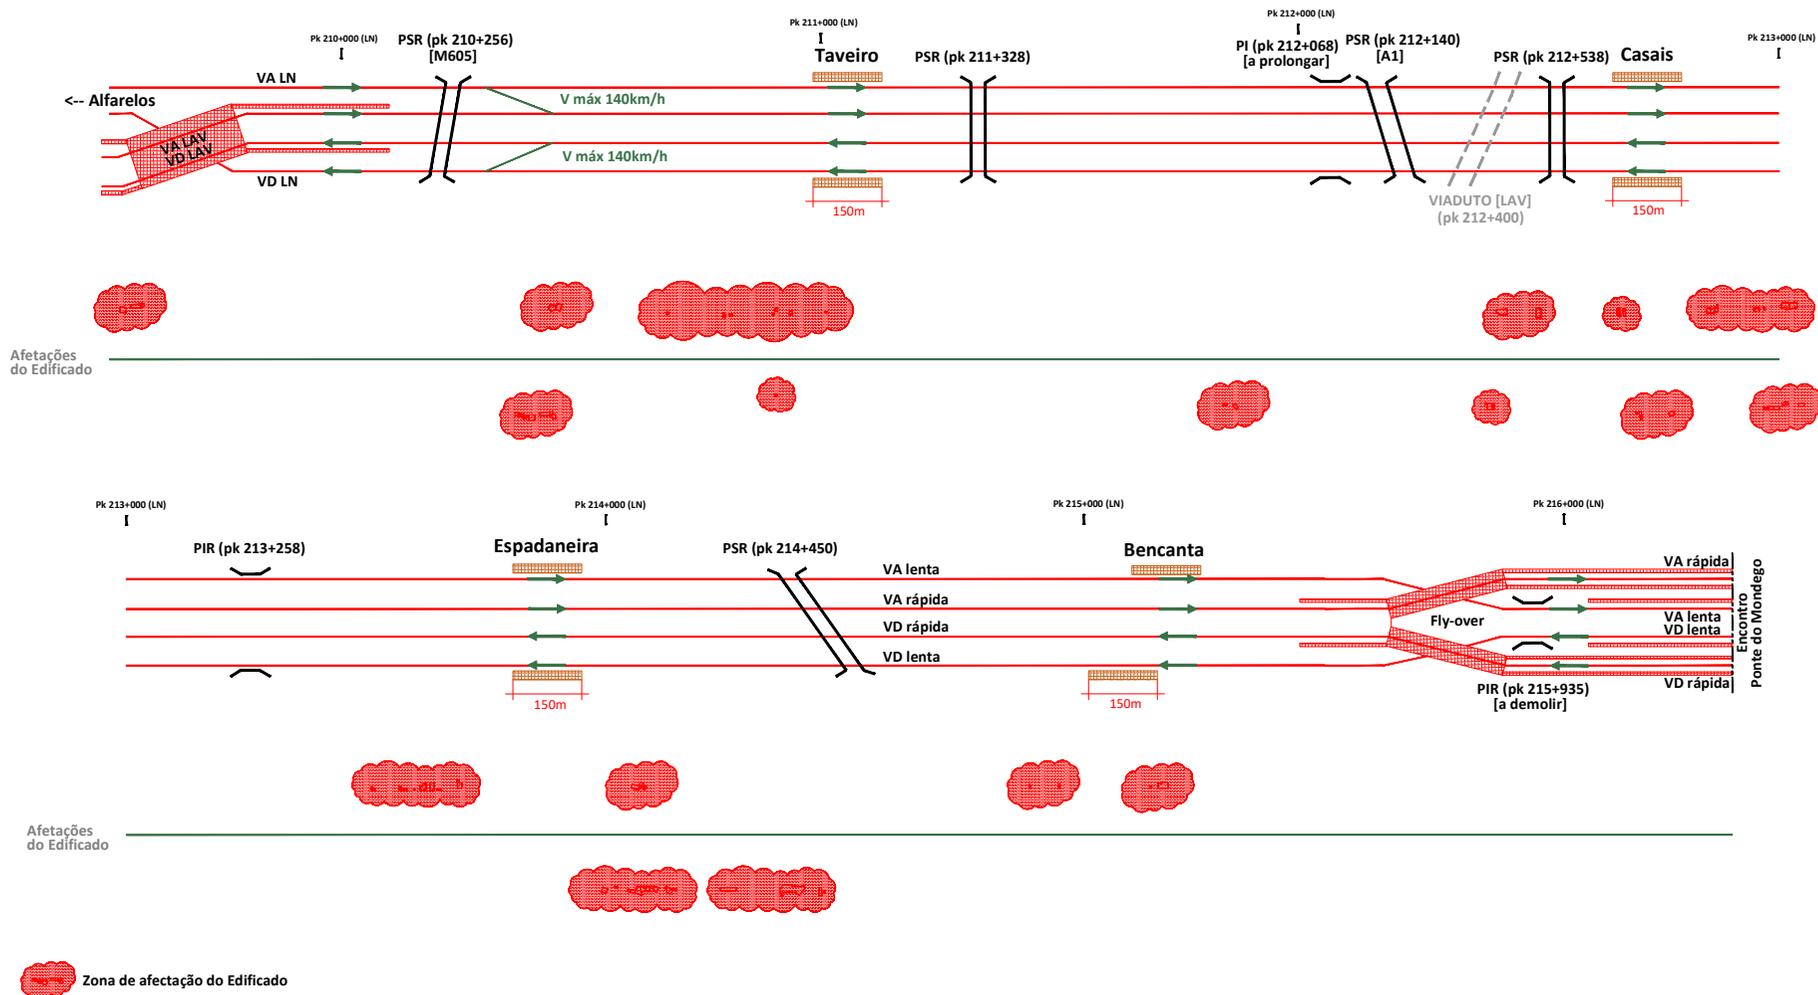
Esquema de Localização do edificado afetado entre Taveiro e Bencanta
